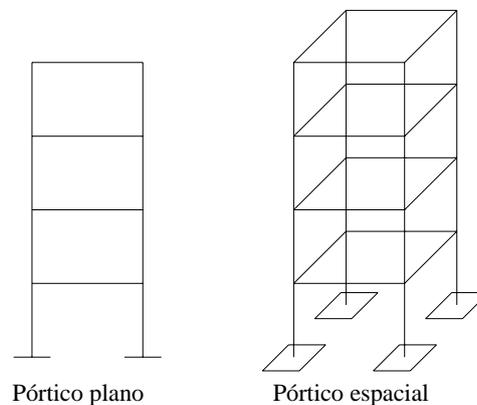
Modelos estruturais – Pórtico plano e espacial
